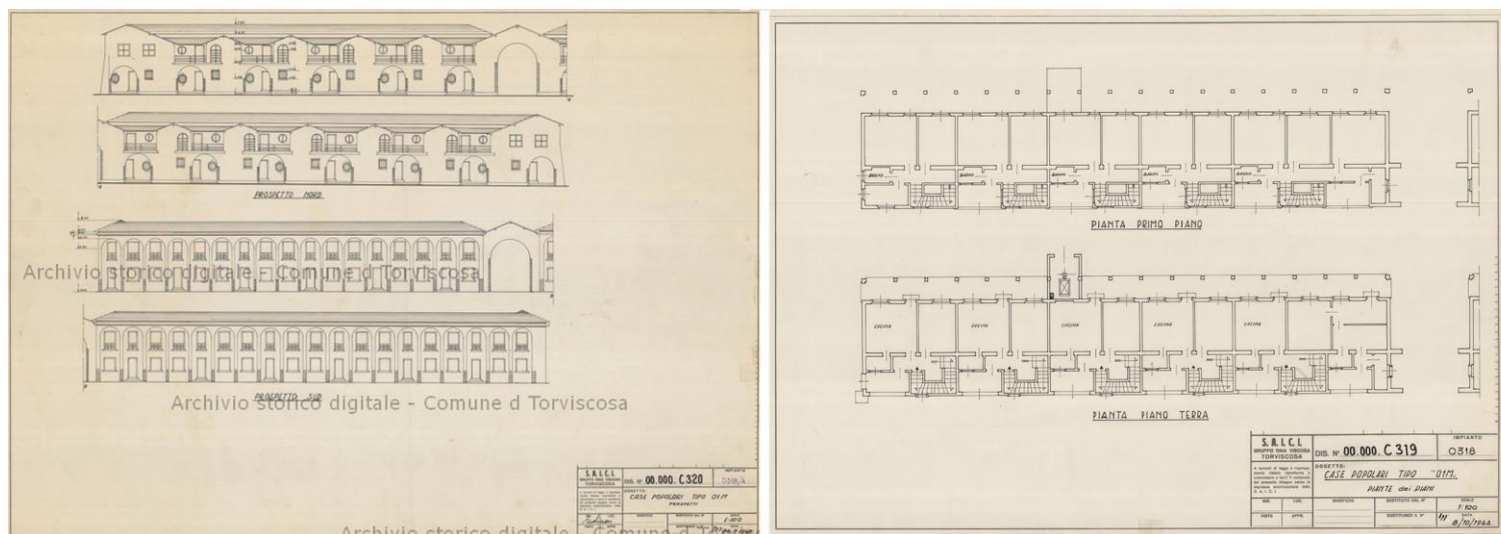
Case operaie tipo 01M. Progetto prospetti nord e sud, blocchi 0324-0318 (sinistra); piante piano terra e primo piano, blocco 0318 (destra).
